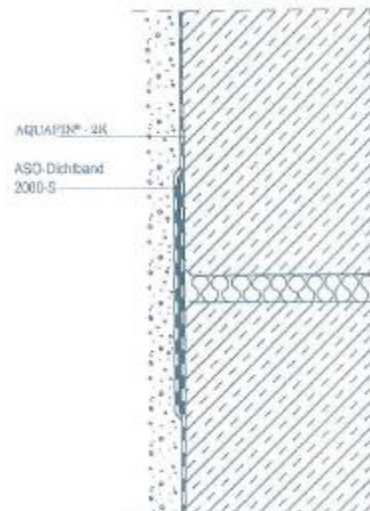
joints de murs de fondation exposés à une pression hydrostatique
